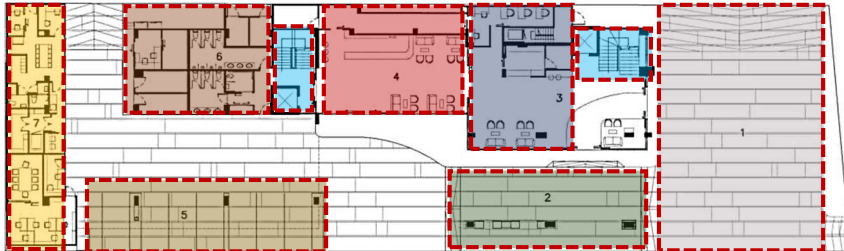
plan rez-de-chaussée srinakaran hotel traité par l'auteur
